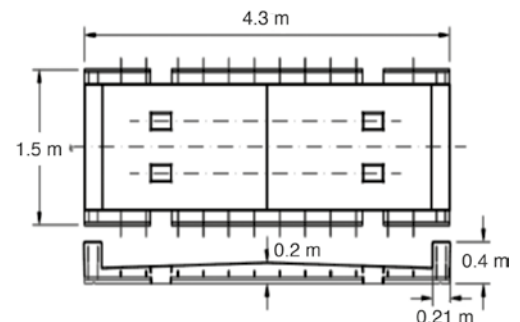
Losa prefabricada de concreto prefabricada típica
